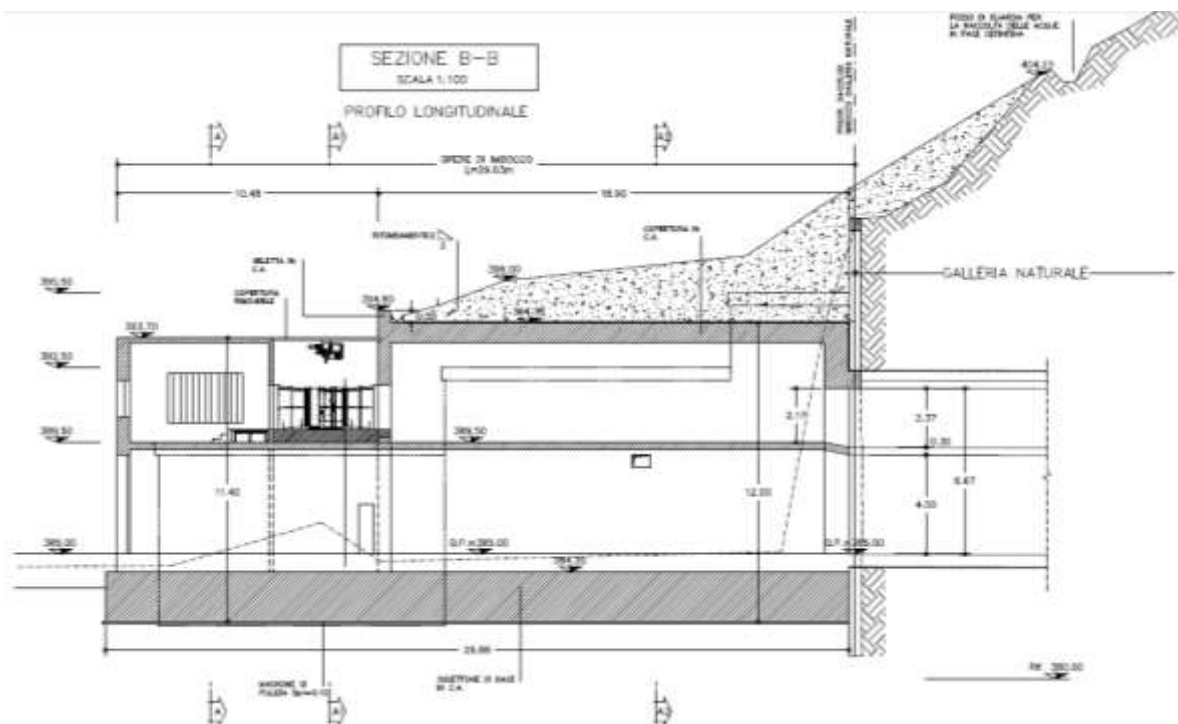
Sezione - Fabbricato FA93 – progetto approvato
